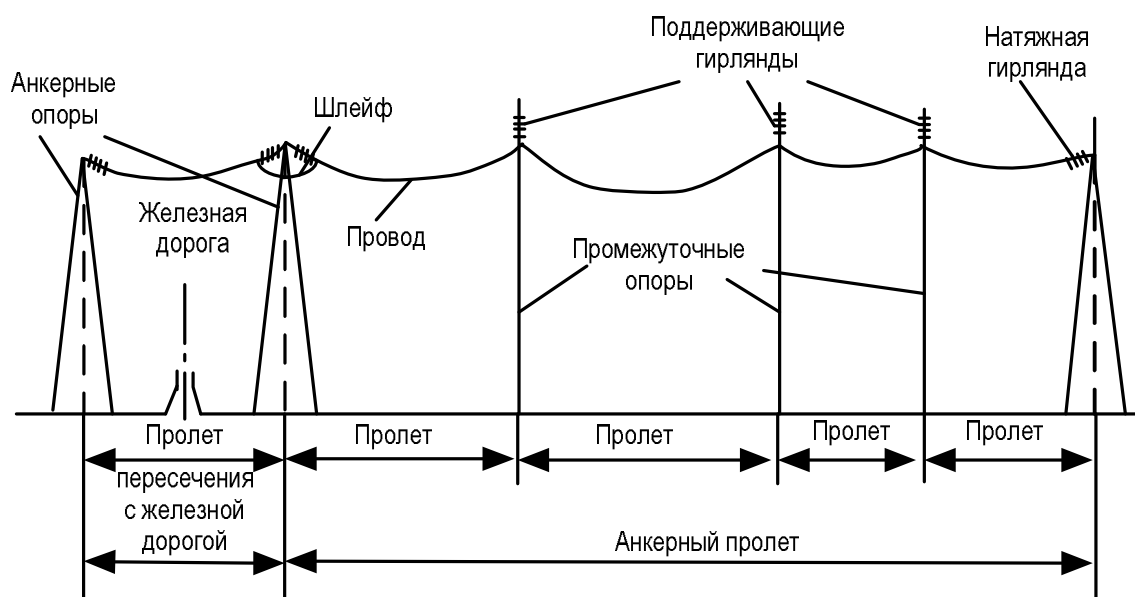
Схема анкерного пролета ВЛ и пролета пересечения с железной дорогой
